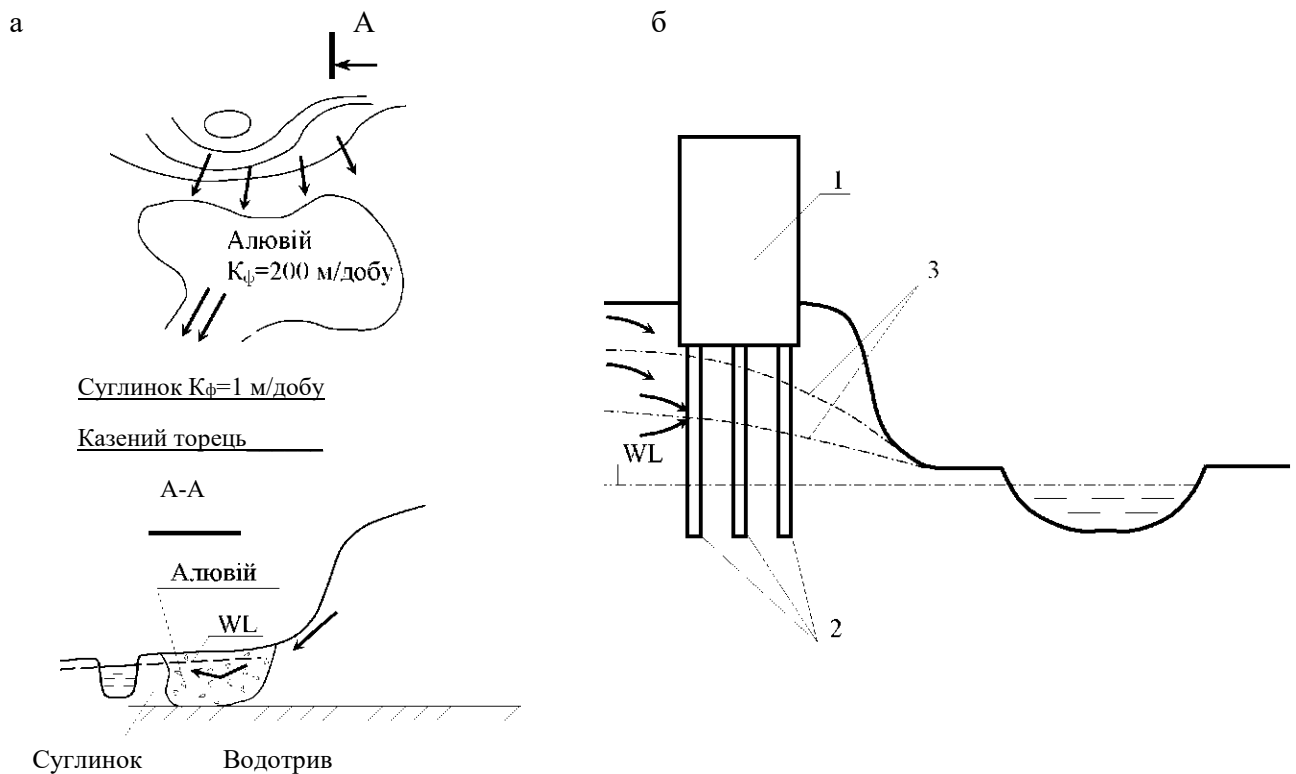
Схеми підтоплення територій: *а* - природного характеру; *б* - техногенного характеру (барражний ефект); 1 - споруда; 2 - пальові фундаменти; 3 - зміна рівня ґрунтових вод, зумовлена барражним ефектом водонепроникності на сульфатостійких цементах. Інформація про заходи захисту повинна міститися в примітках робочої документації.
